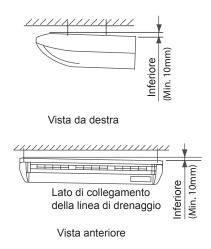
Inclinazione dell'unità per il drenaggio (installazione a soffitto)
